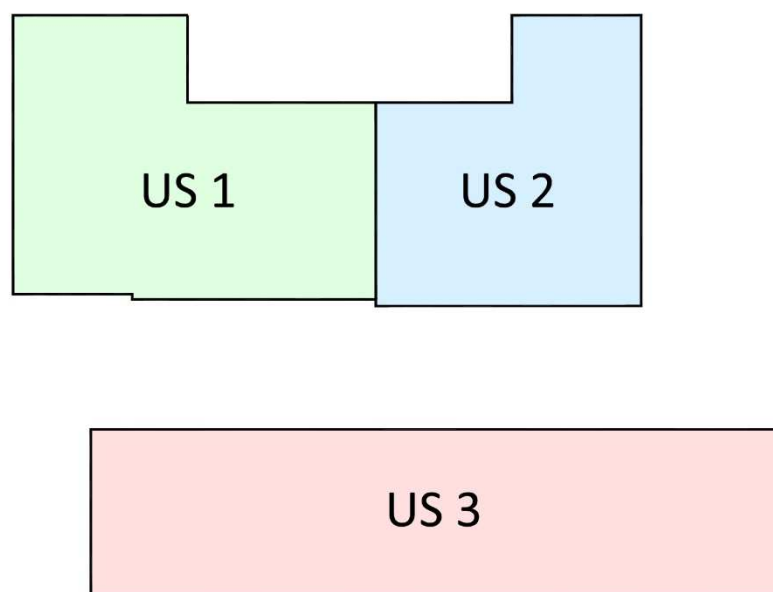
Suddivisione dell'edificio in Unità Strutturali.
